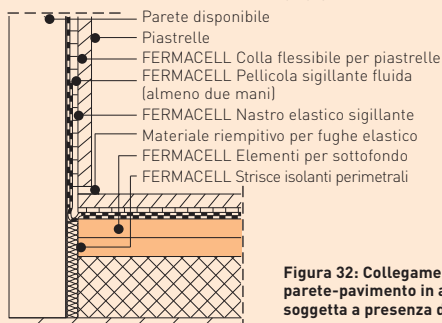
Collegamento parete-pavimento in area soggetta a presenza d'acqua
